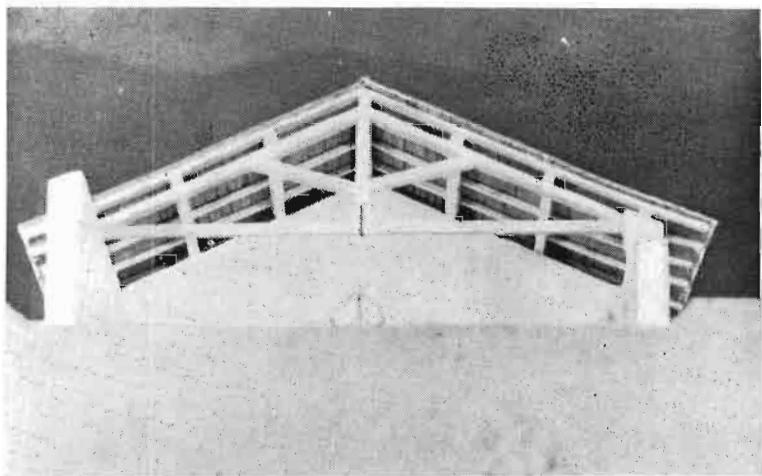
Cubierta acabada armada sobre una cercha a la española. (Foto I. N. C.)
